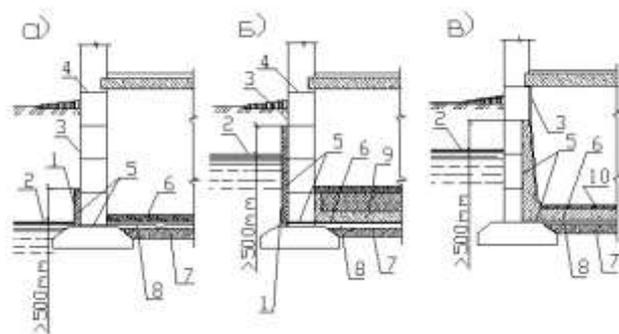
Гидроизоляция подвальных помещений при небольших (а) и при больших (б, в) напорах подземных вод;
